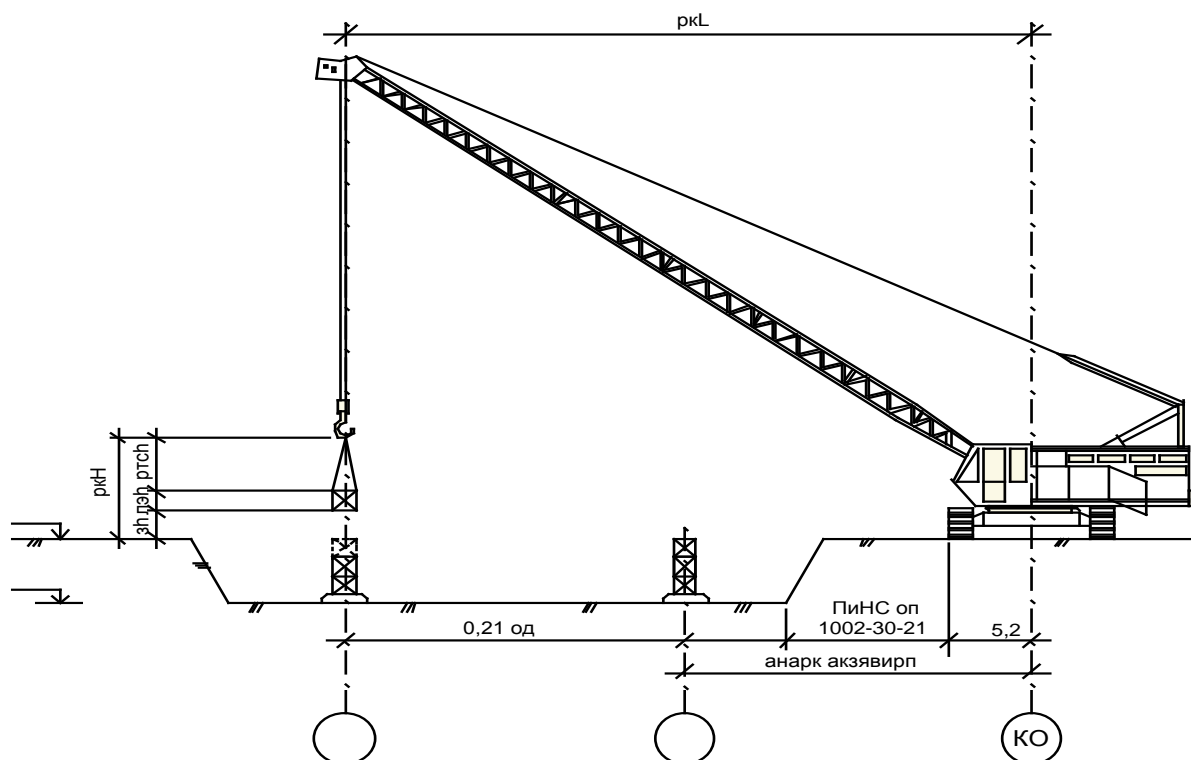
Установка крана при монтаже фундаментов с одной стороны здания.
